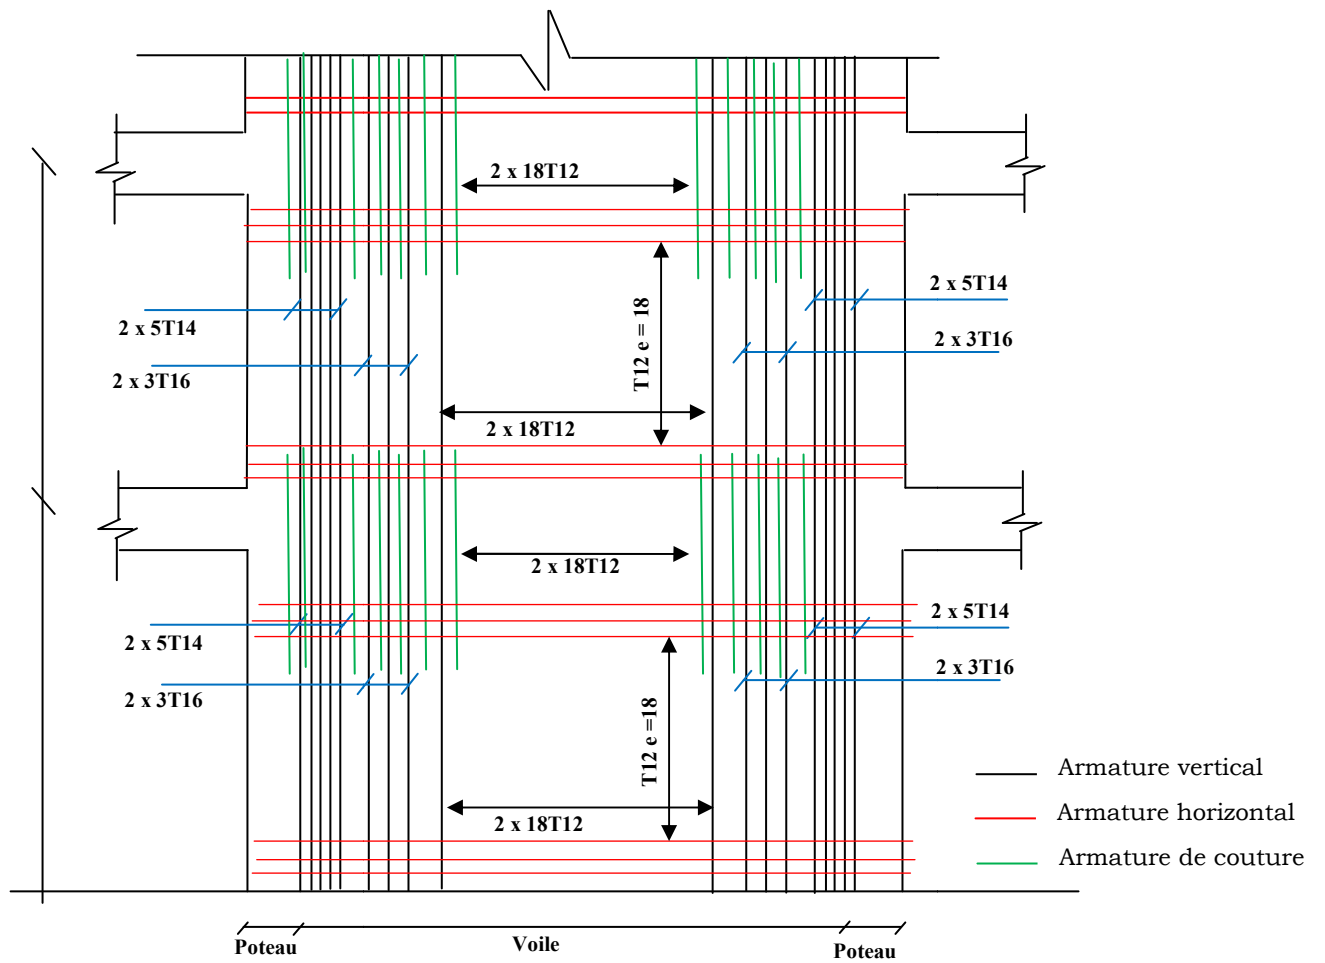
Détail Ferrailage Voile 4 en élévation
